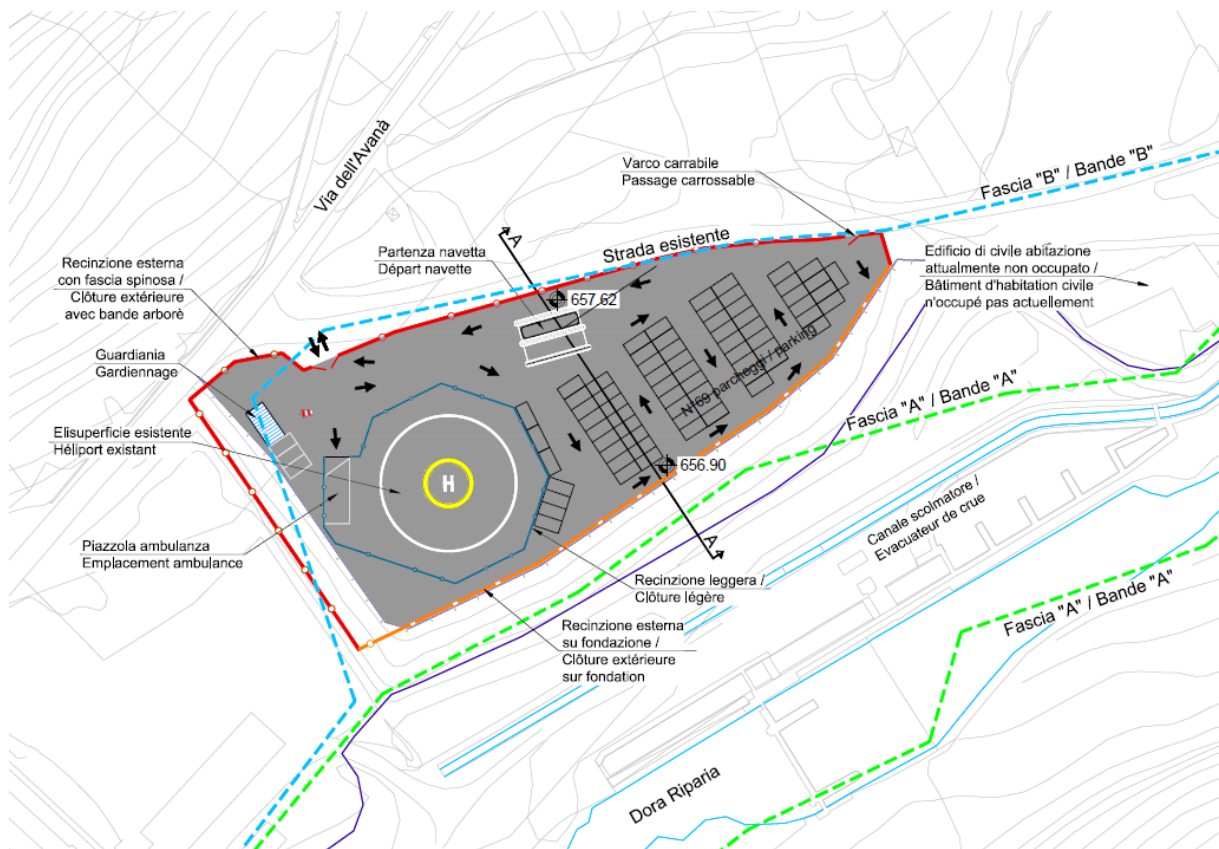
Layout dell'Area di Colombera (a supporto del Cantiere di imbocco di Maddalena)
